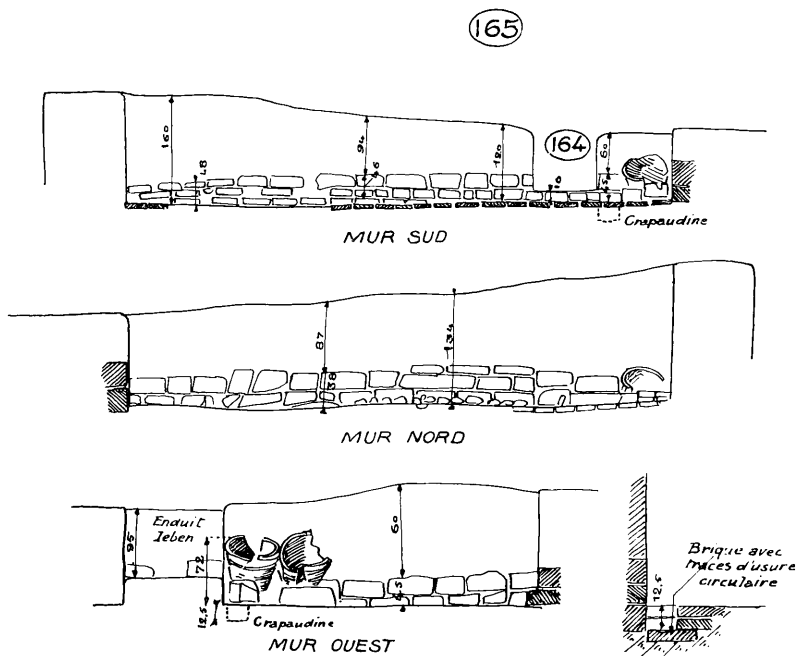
Coupe des murs de la salle 165 avec fondations de pierre.
